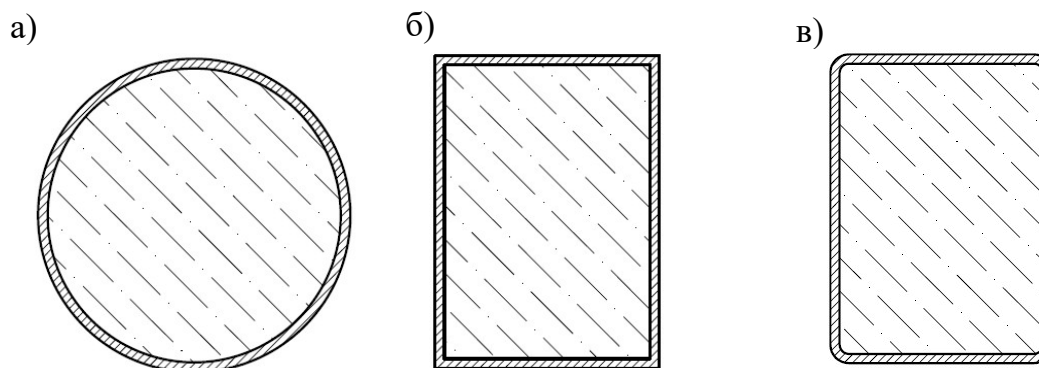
Сечения трубобетонных элементов: а) круглое; б) прямоугольные сварные; в) прямоугольные из холодногнутой профилей
